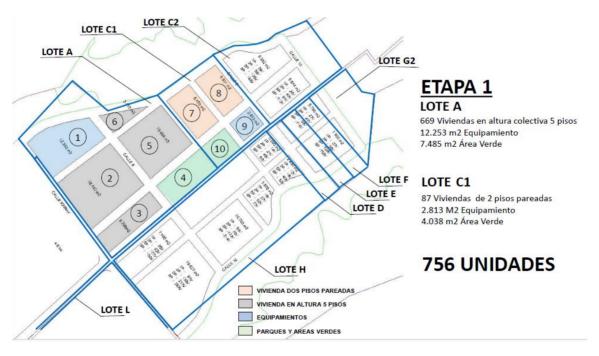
Etapa I. Plan maestro Llanos de san Fernando lote A y C1, D.S.49.
